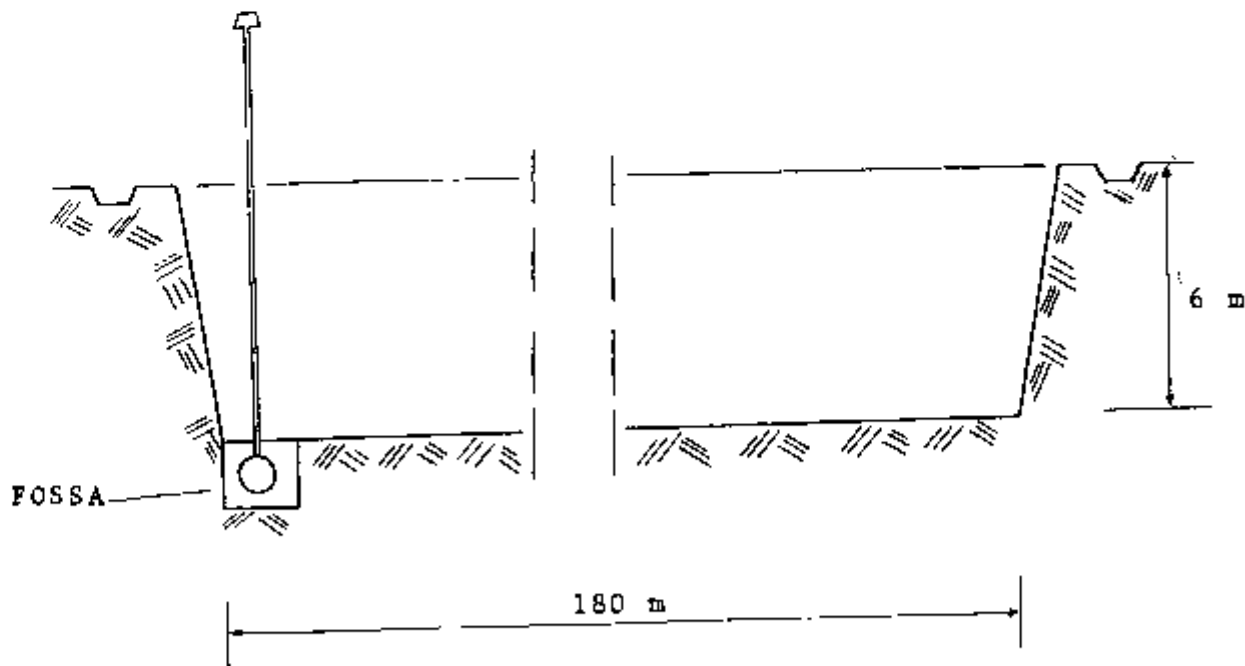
DETALHES DA SECÇÃO LONGITUDINAL DE UMA TRINCHEIRA RECOBERTA
